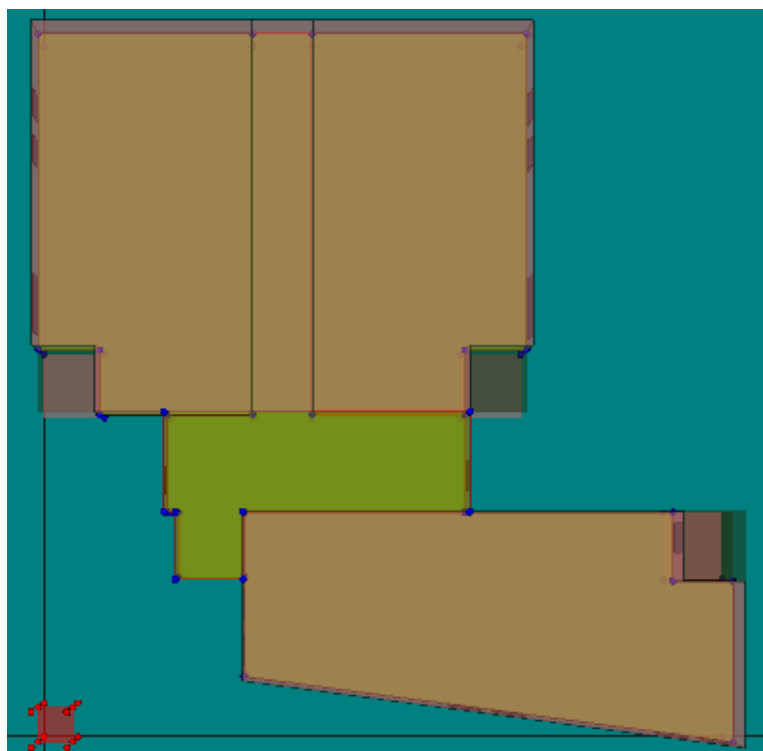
Vista planta de la planta primera. Fuente: Propia, HULC.
